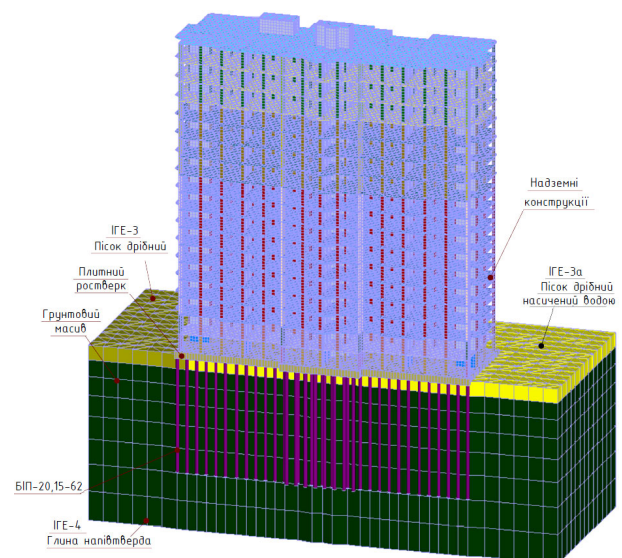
Скінчено-елементна модель системи «ґрунтова основа – фундамент - будівля»
